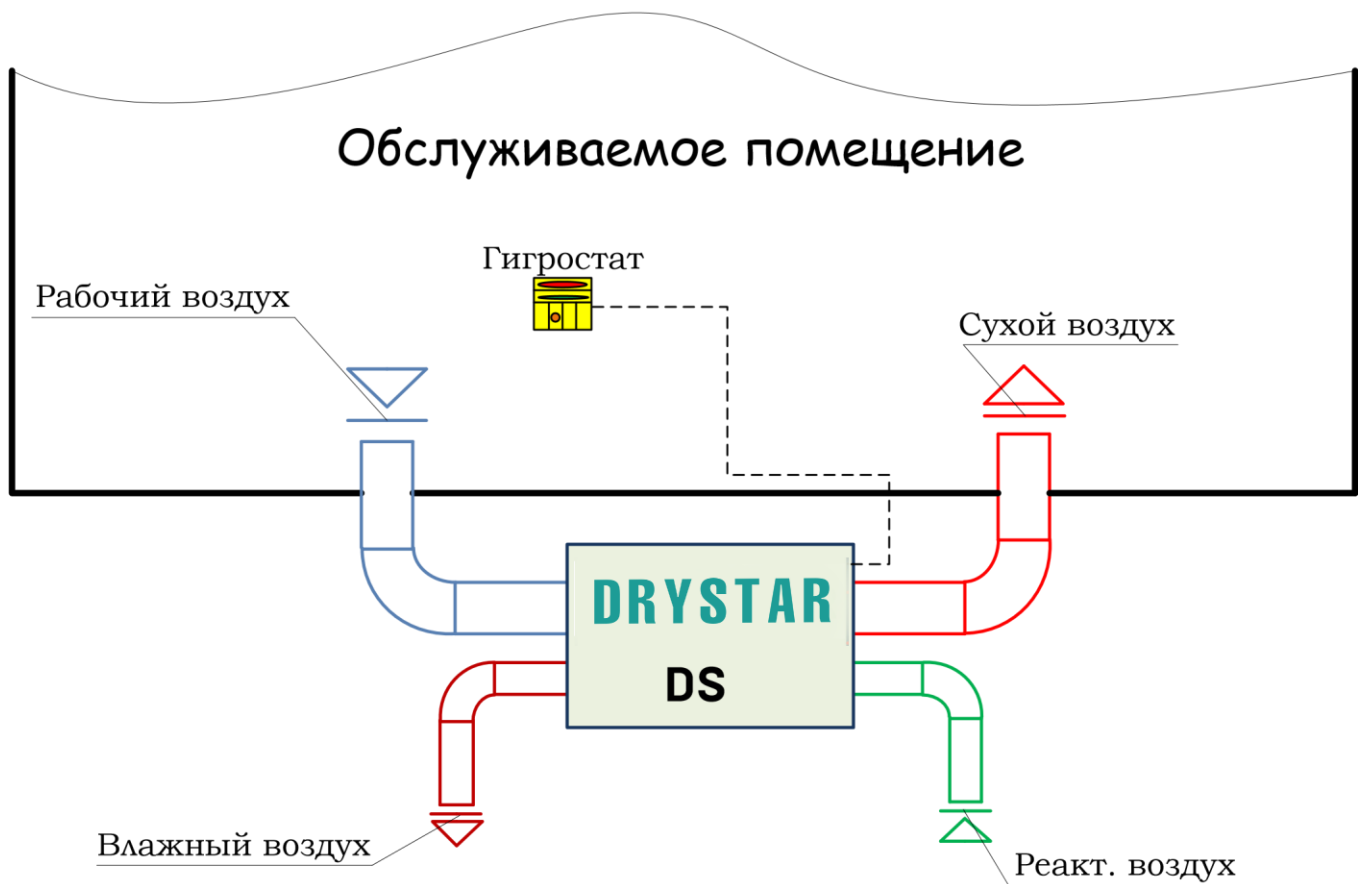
Работа осушителя по «закрытой» схеме (наружное исполнение)
